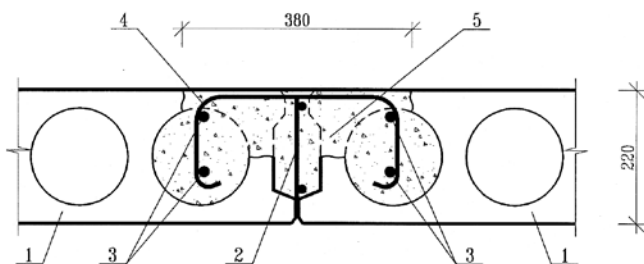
Монтажный узел многопустотных плит перекрытий:
